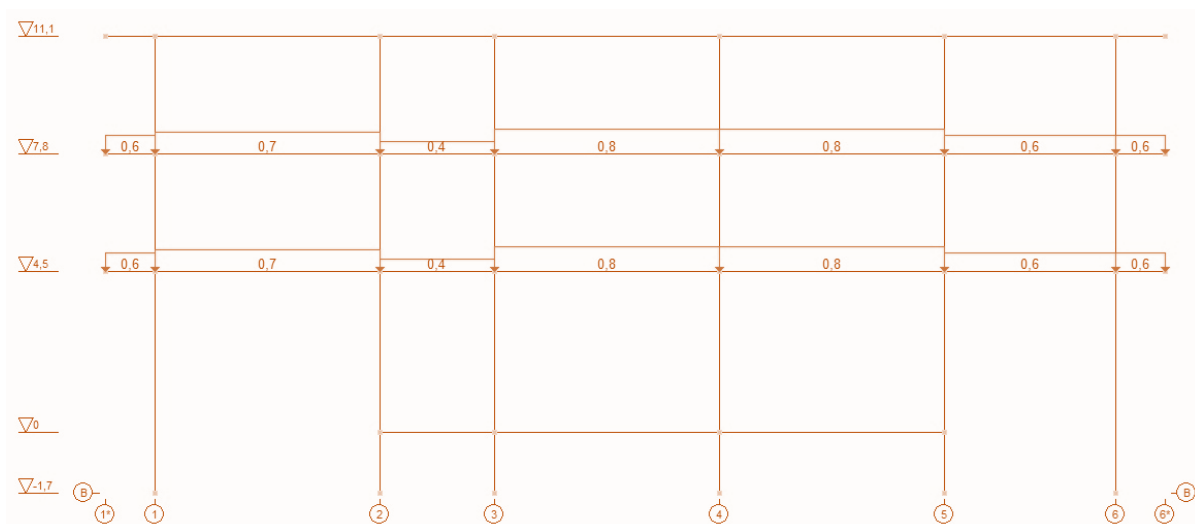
Корисне навантаження на перекриття 2-го і 3-го поверхів
